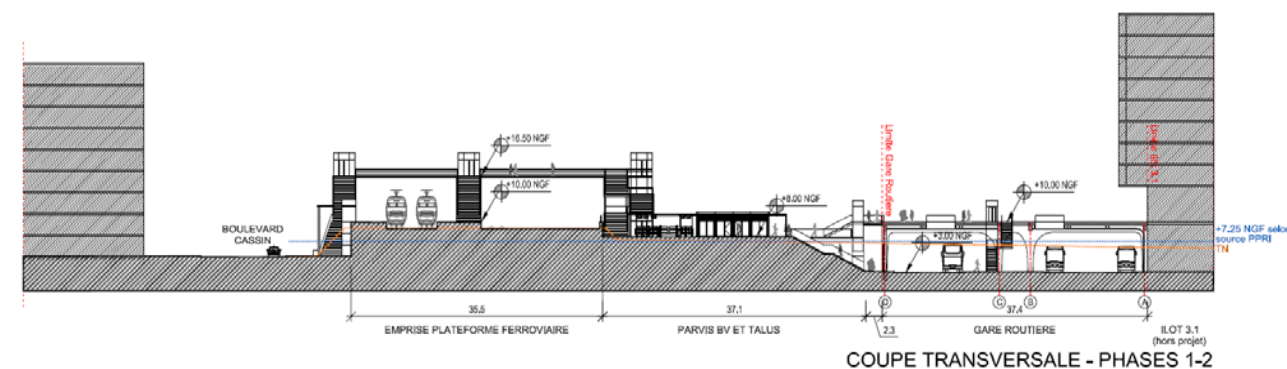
Coupe transversale, projet du PEM. (source: AREP).
